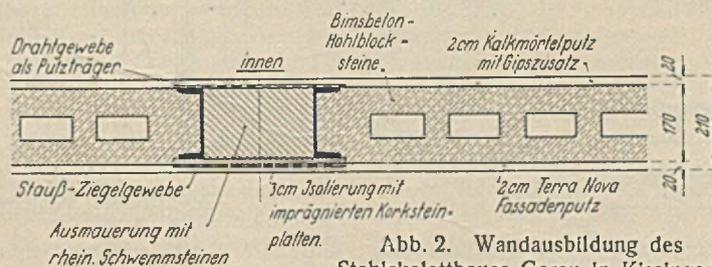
Wandausbildung des Stahlskelettbauens Garau in Kissingen.
